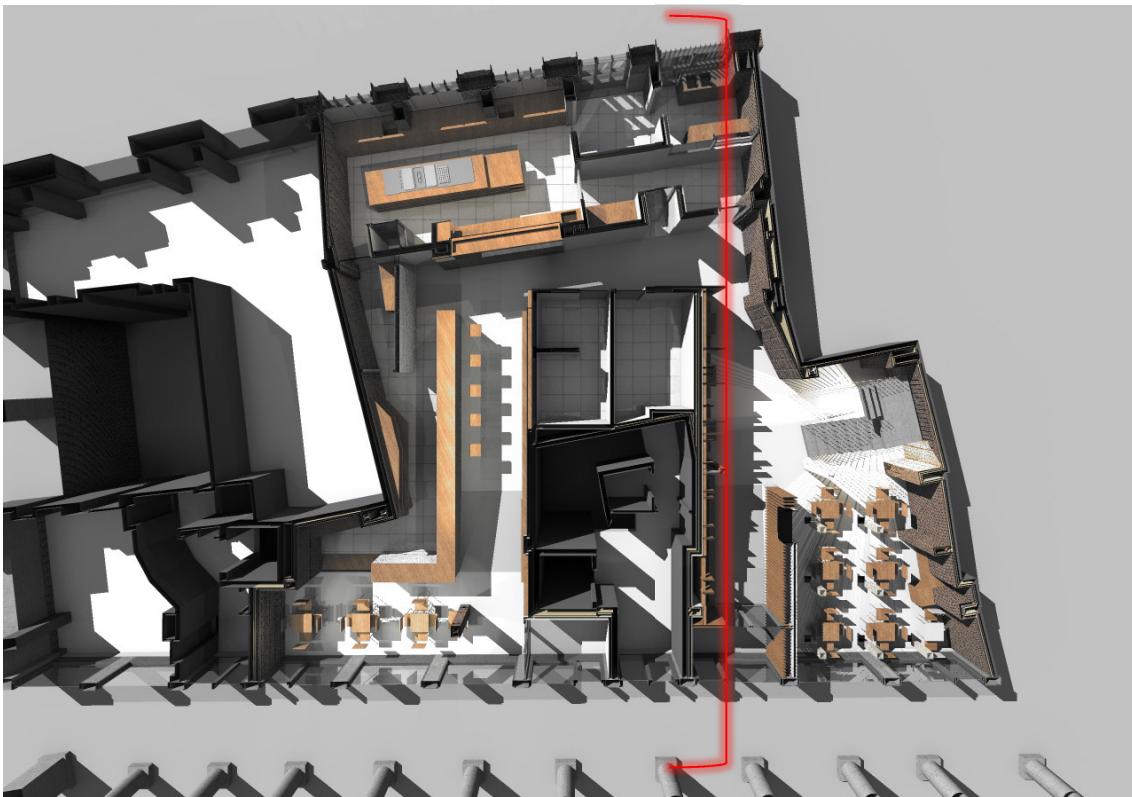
49_ Planta baja, estado reformado. La línea roja muestra el plano de corte correspondiente a la sección representada en la Figura 7.52.
